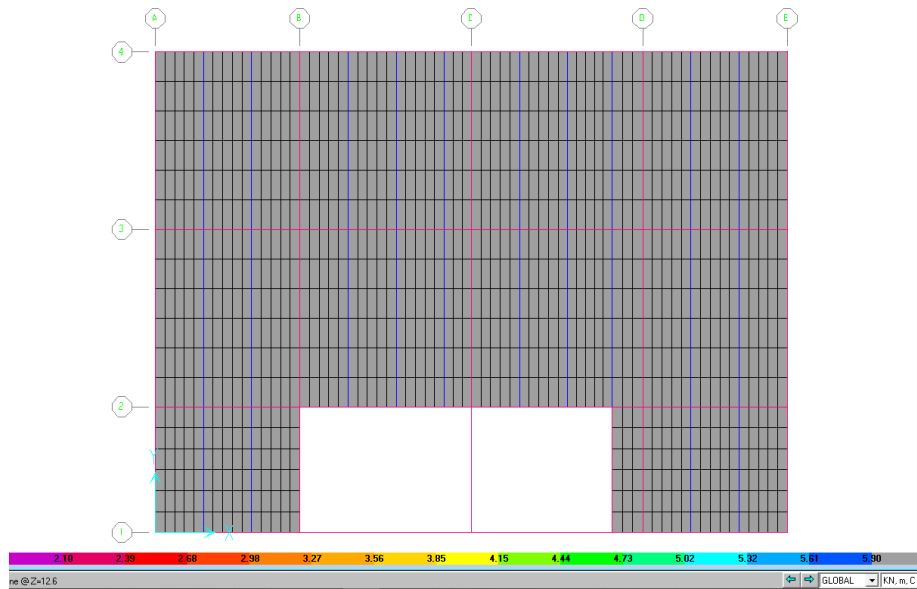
Planta nivel mezzanine módulo de acceso estación 19 costado nor oriental aplicación de la carga muerta (5,9 kN/m<sup>2</sup>)
